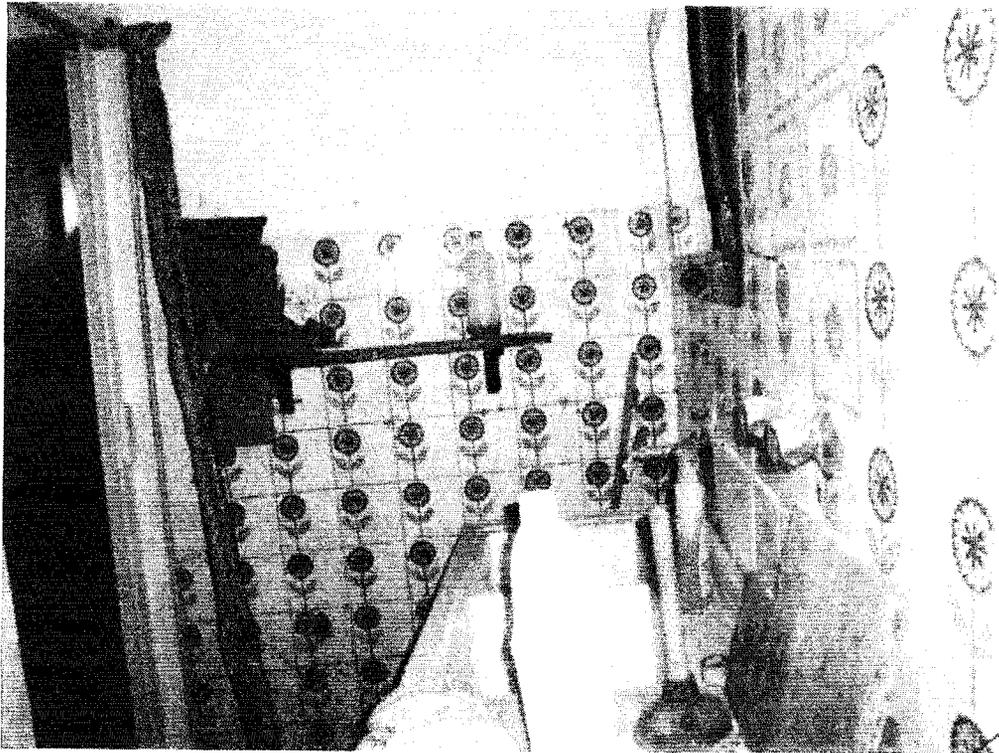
vista del bagno, privo di illuminazione ed aerazione diretta, verso la porta di accesso allo stesso
